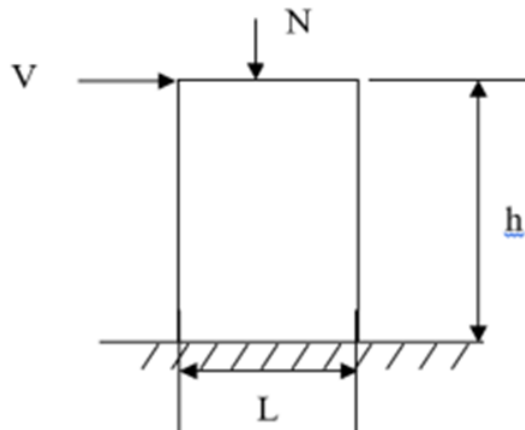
Schéma d'un voile. (Okacha, 2021)
